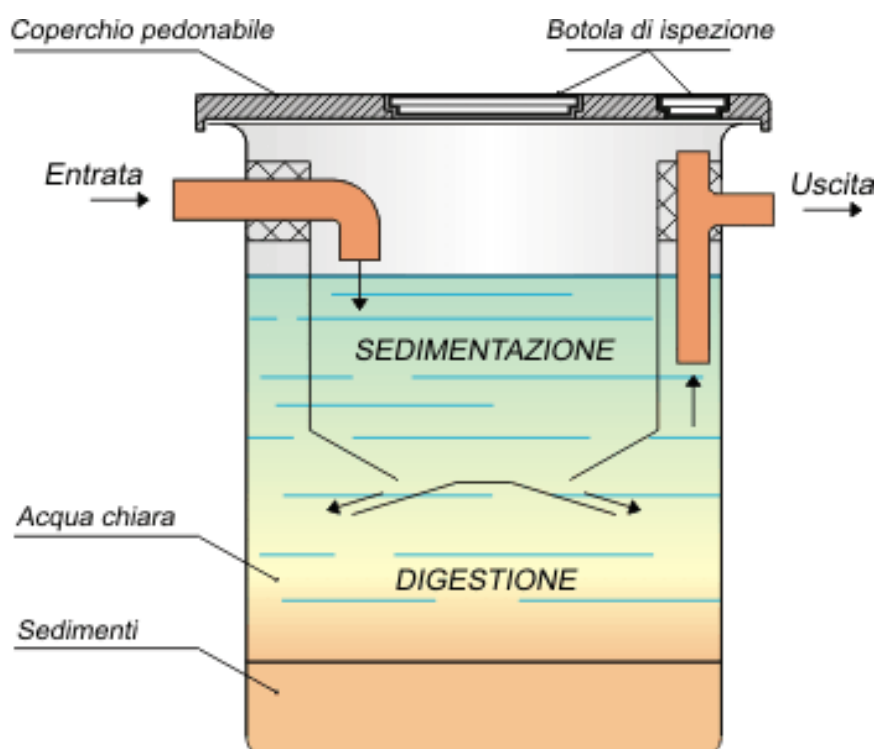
Vasca Imhoff a pianta rettangolare.
